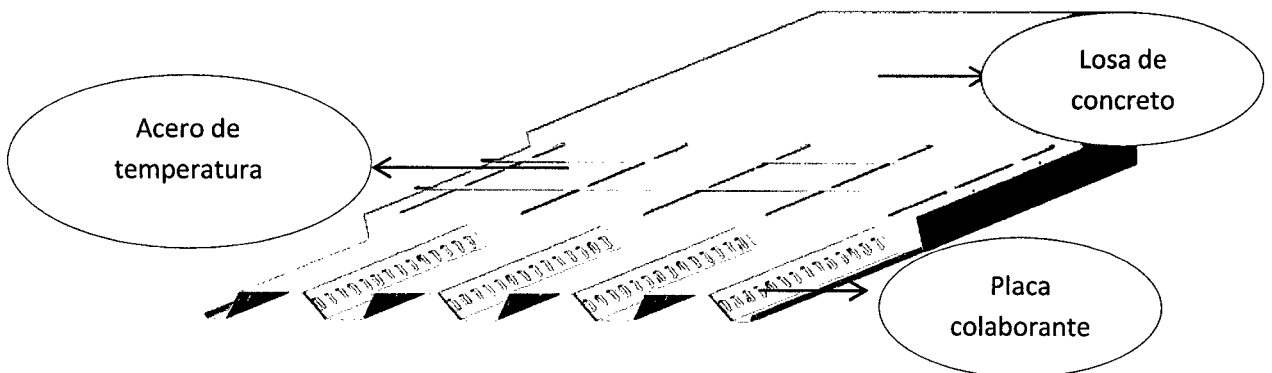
17: Estructura de un sistema de losa colaborante (Ascencio, 2006)
